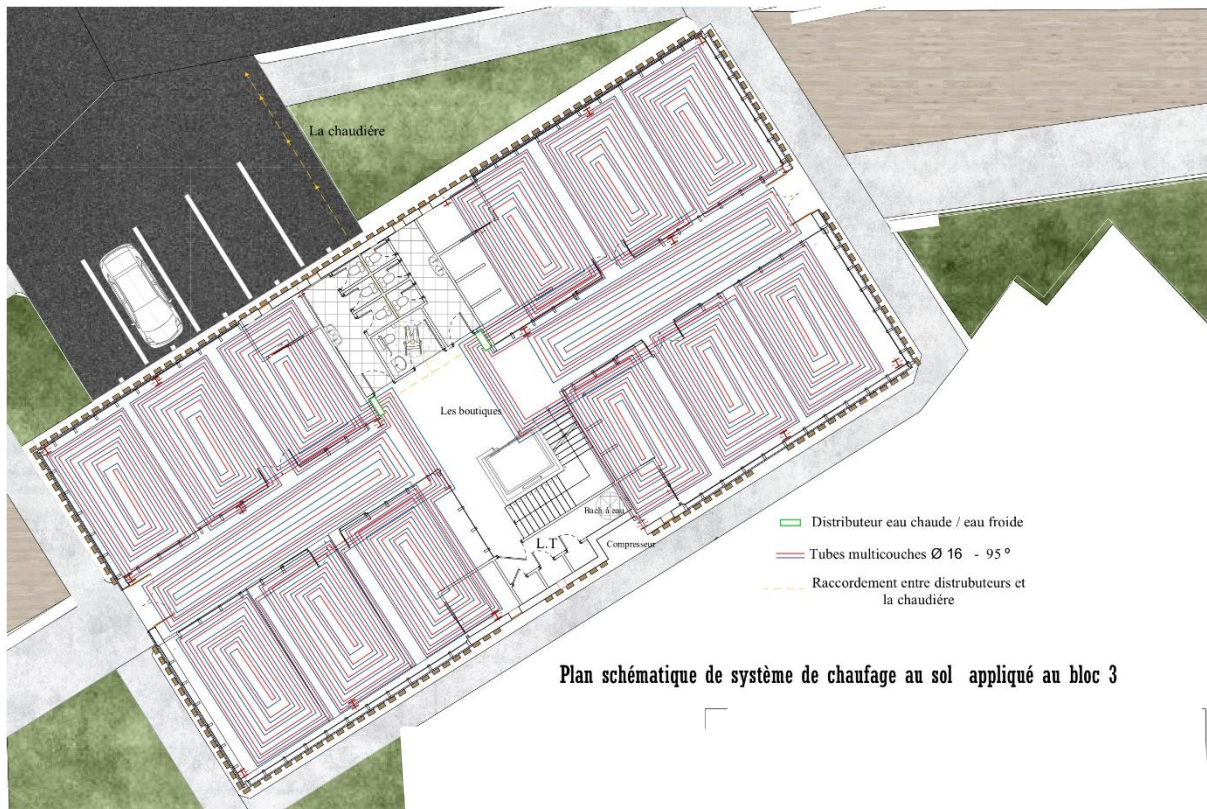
Plan schématique de l'installation du système de plancher chauffant appliqué au bloc 03
